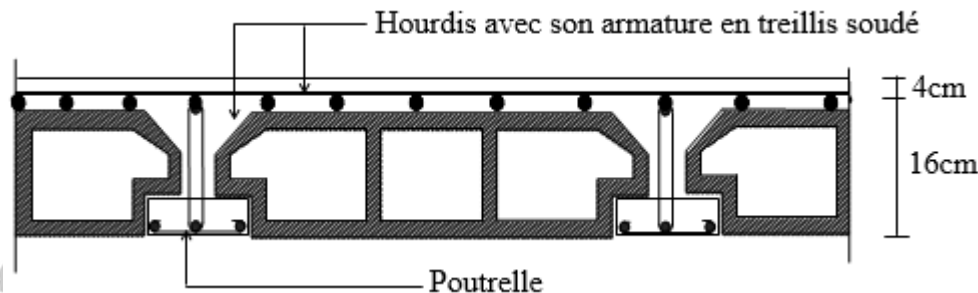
Coupe transversale d'un plancher en corps creux
